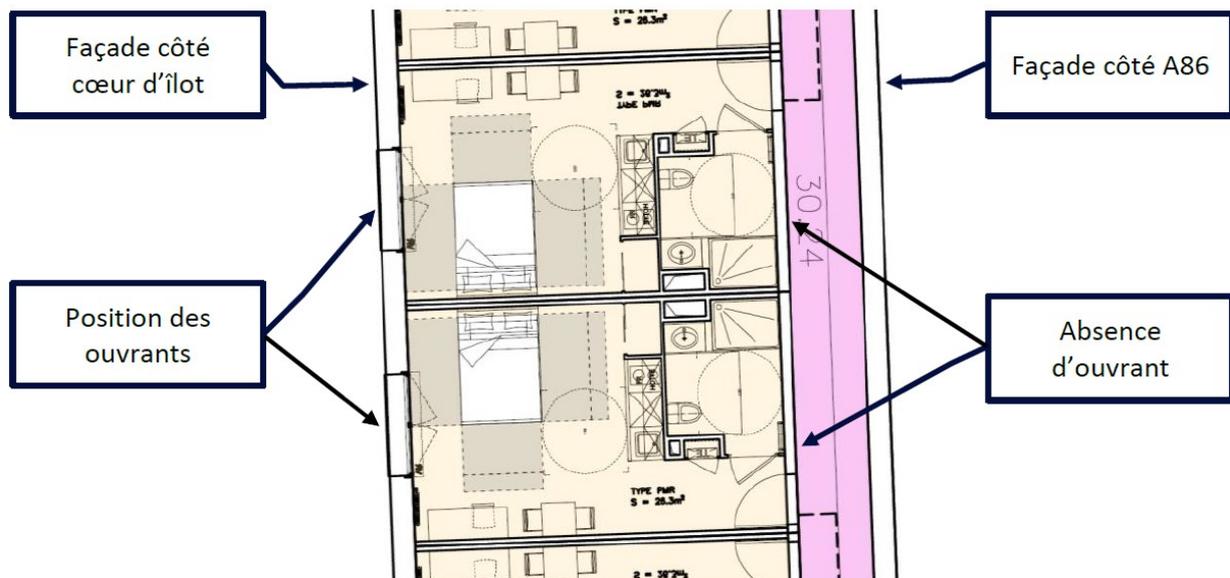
Plan des futurs logements en façade de l'A86 (R+3)
